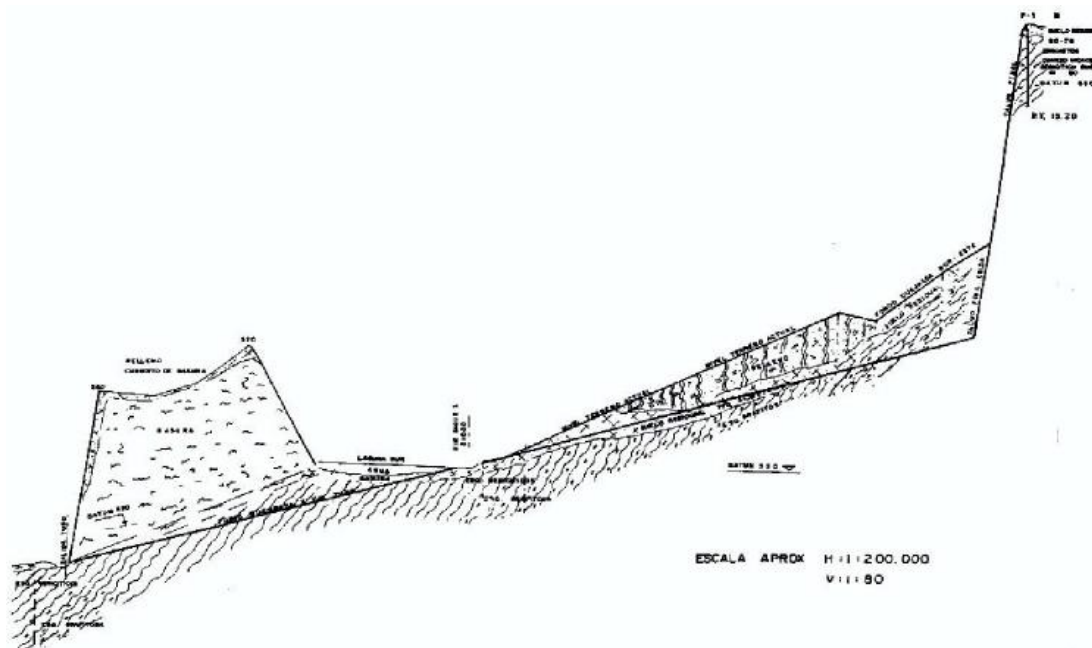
Perfil Longitudinal del Cauce de la Quebrada El Vegote
